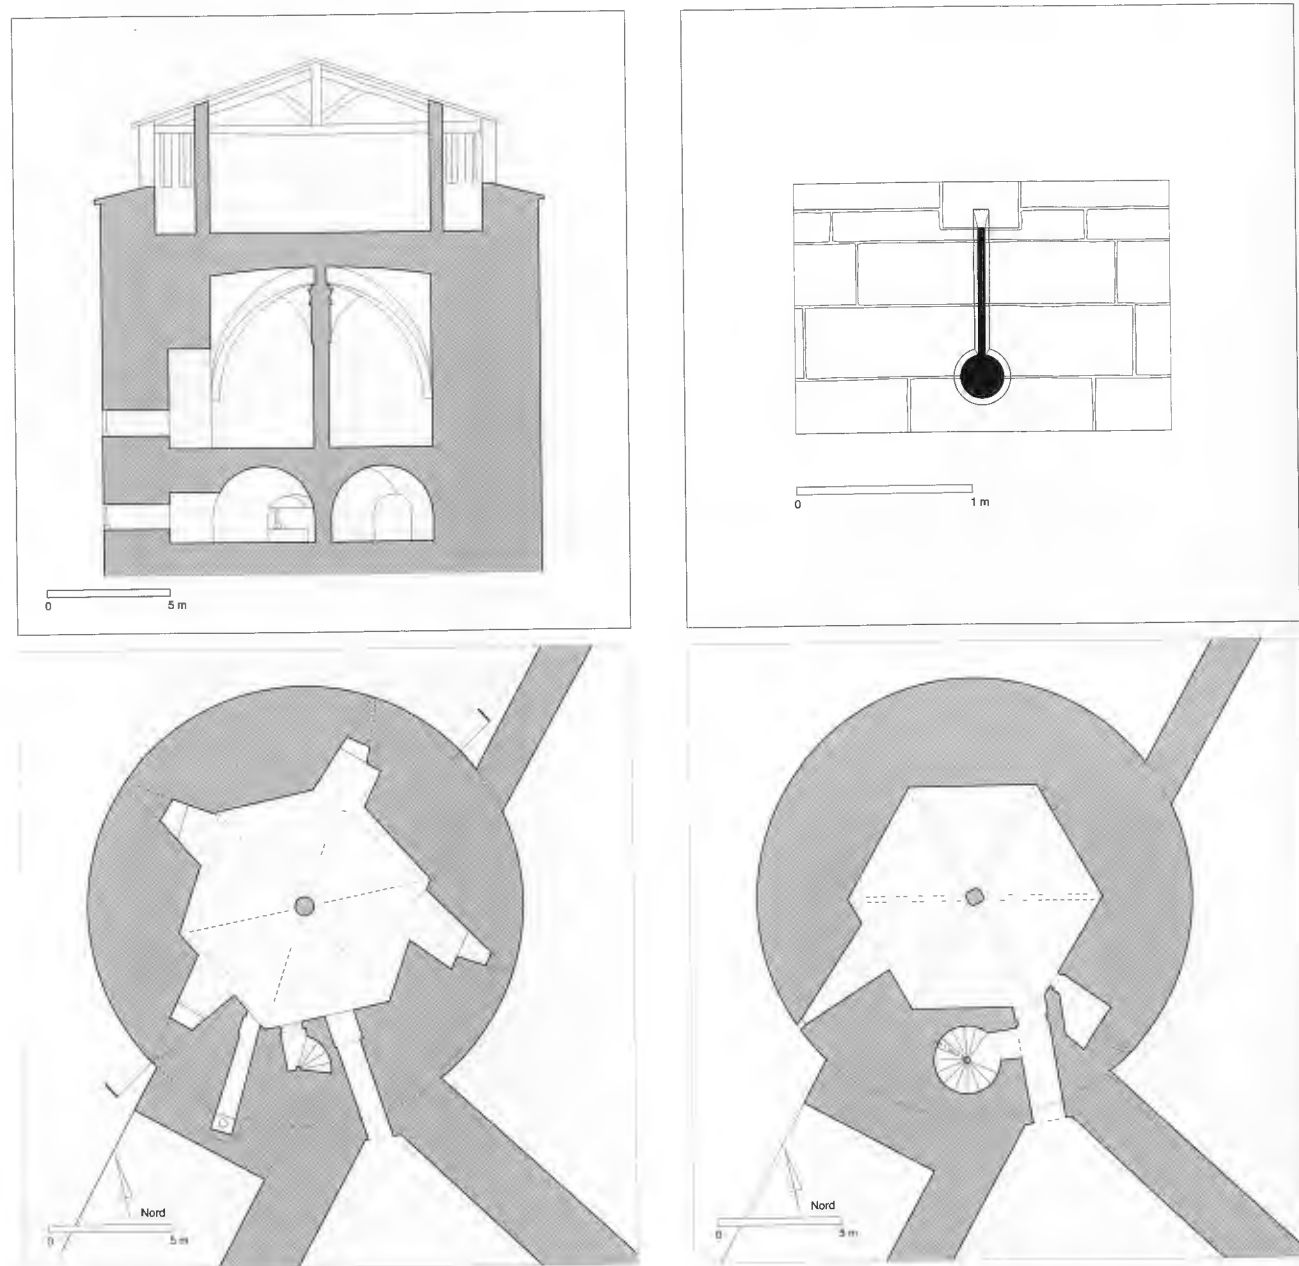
Fort du Hâ, tour des Minimes, coupe et plans, dessin Philippe Dangles.
